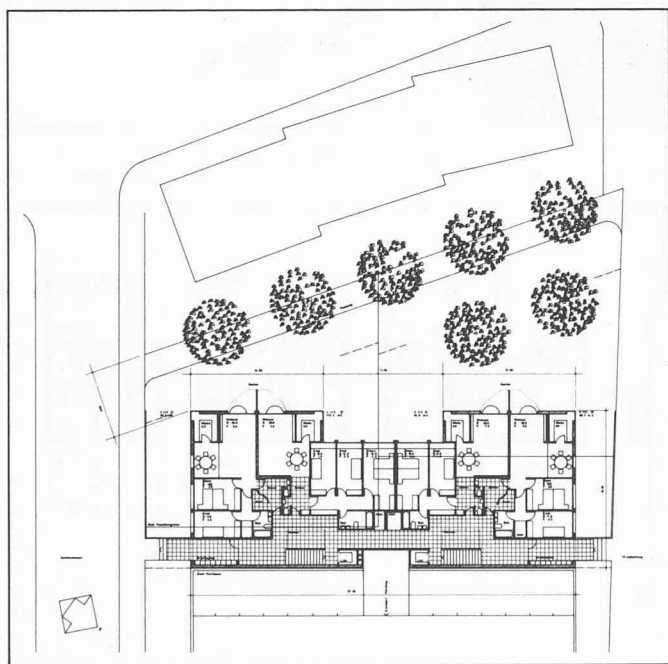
Immeuble Gartenstrasse: vue en plan.
